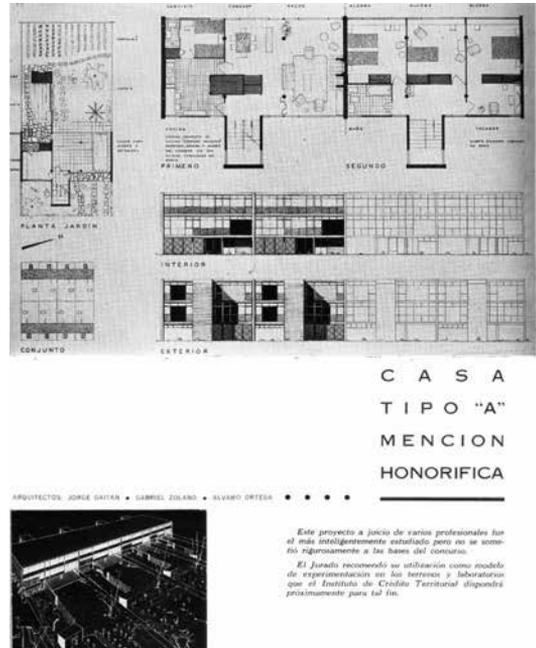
Planos presentados al concurso por Gaitán, Ortega y Solano. Fuente: revista Proa, n.º 25
